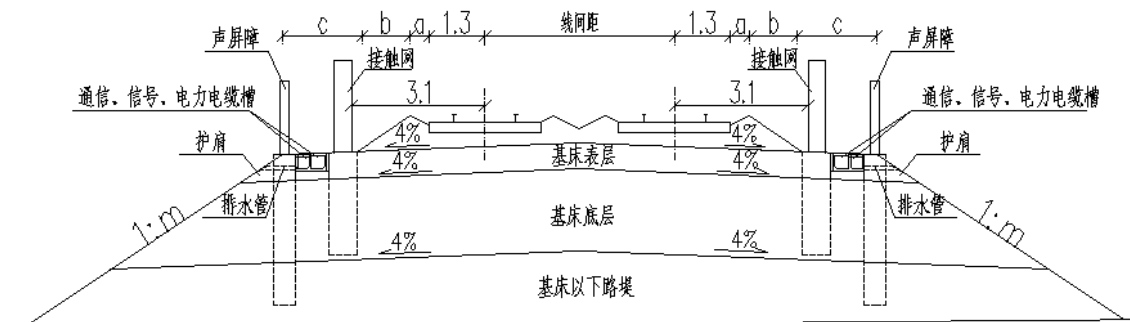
有砟轨道双线路堤横断面示意图（单位：m）
